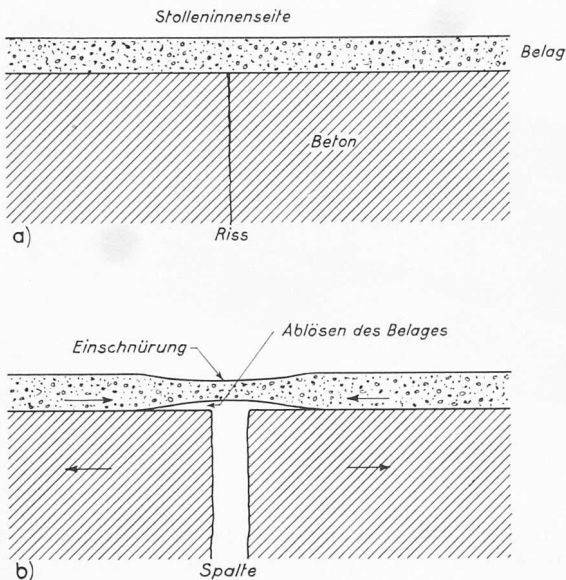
Verhalten eines Belages über dem sich erweiternden Riss im Beton
